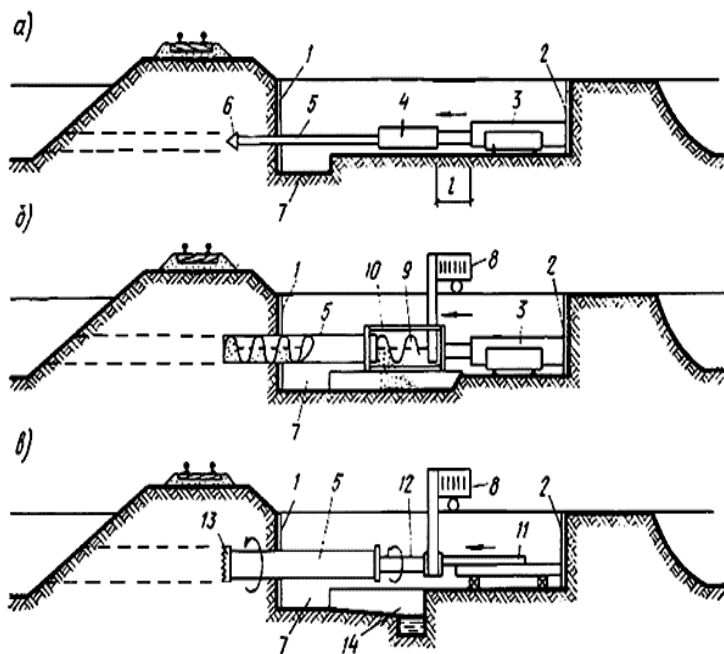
Закрытые способы разработки грунта: а - прокалывание; б - продавливание; в - горизонтальное бурение; 1 - крепление передней стенки рабочего котлована; 2 - упор, устанавливаемый на задней стенке рабочего котлована; 3 - гидравлический домкрат; 4 - шомпол; 5 - труба; 6 - конический наконечник; 7 - приямок для наращивания трубы; 8 - привод; 9 - шнековое устройство для извлечения грунта из трубы; 10 - рама, передающая давление; 11 - реечный домкрат; 12 - вращающийся шпindel; 13 - режущая коронка; 14 - лоток и приямок для пульпы.
